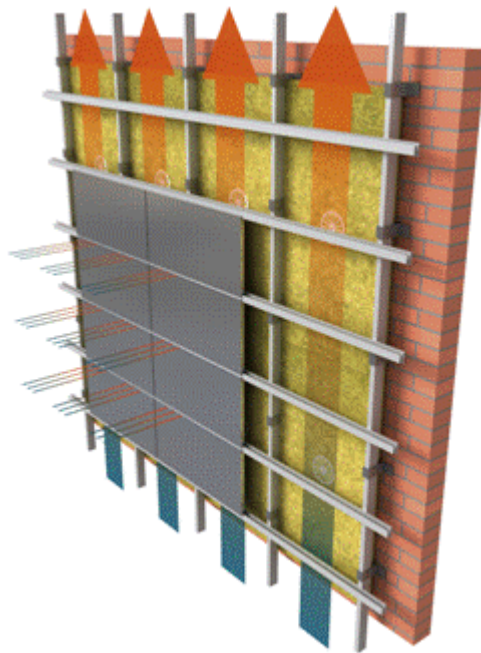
Perspectiva fachada ventilada. Fuente Rockwool.es
